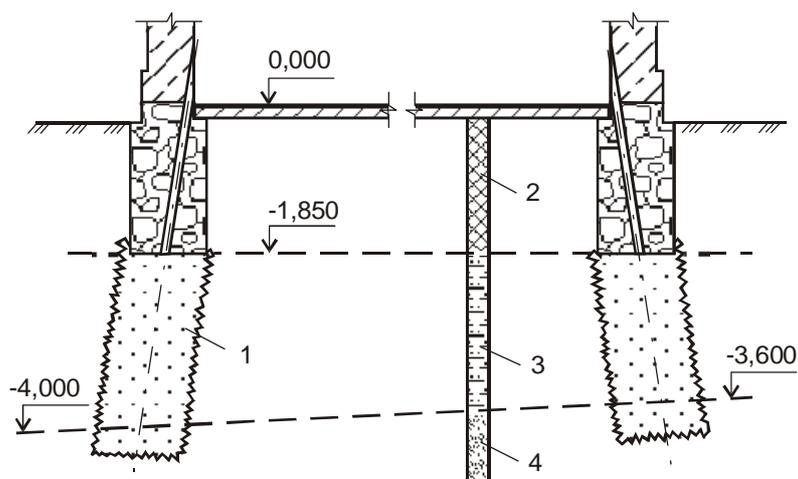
Пересадка здания на опоры, устроенные с использованием струйной технологии: 1 – опора; 2 – насыпной грунт; 3 – мягкопластичный пылевато-глинистый грунт с органическими остатками; 4 – гравий
